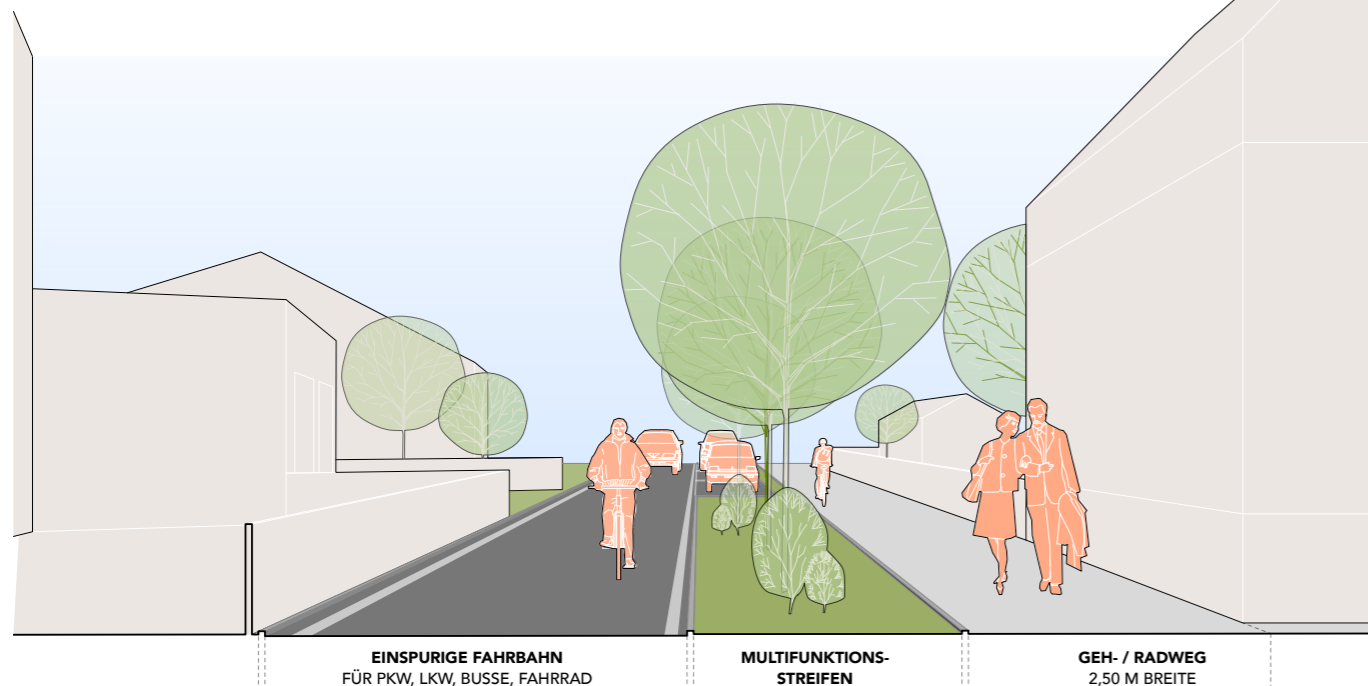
Mögliche Umgestaltung Peuntstraße mit Einbahnstraßenregelung, Blick Richtung Norden
